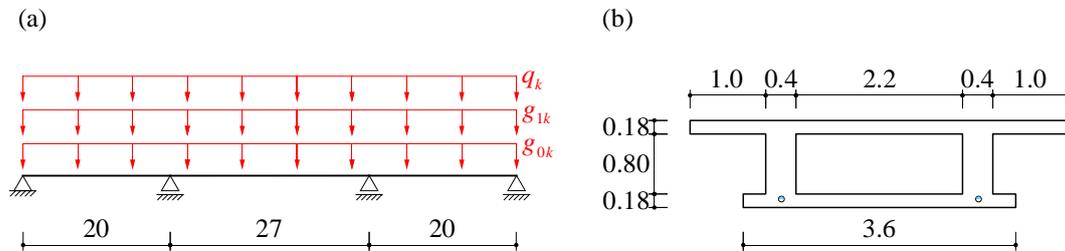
(a) statisches System und Belastung; (b) Querschnitt (Abmessungen in m).
